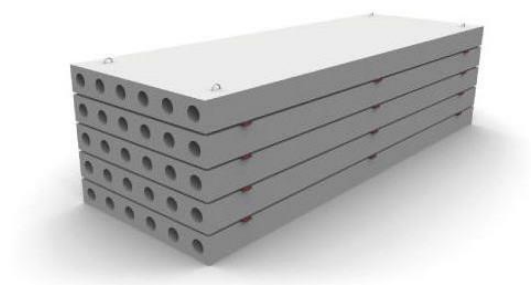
Конструкция железобетонной многопустотной плиты перекрытия
